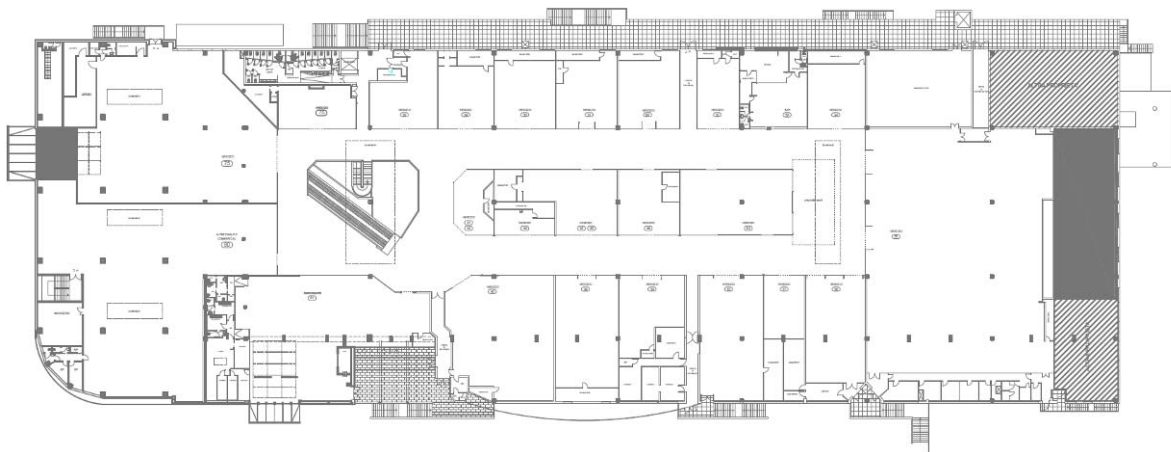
Centro commerciale Tiziano, pianta piano terra, area tratteggiata porzione di altre proprietà con attività alimentare.
